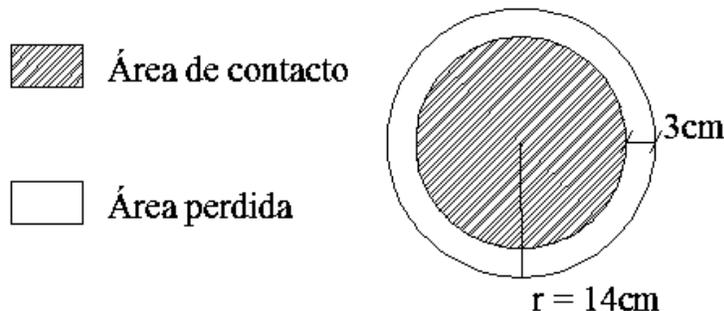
Sección transversal de la columna en estudio. Elaboración propia
